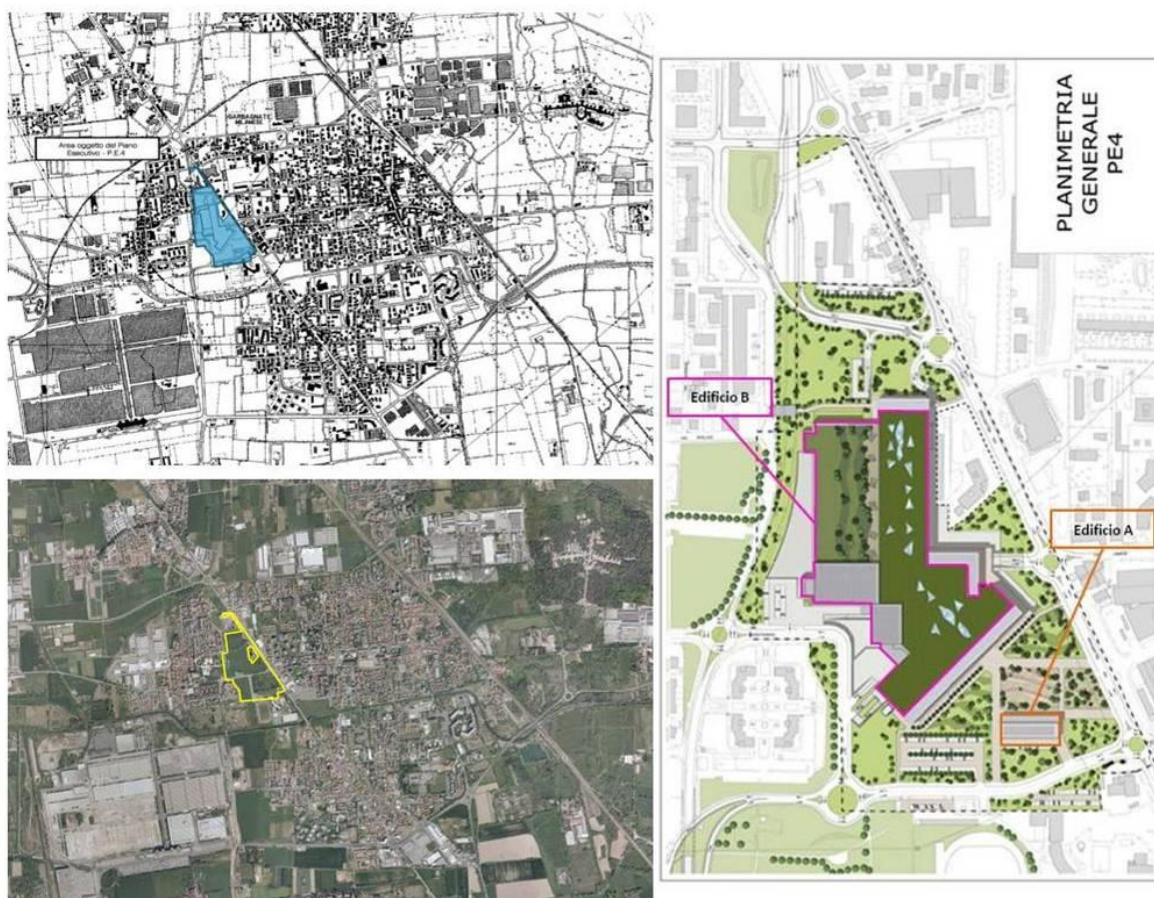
Delimitazione dell'area interessata dal PE4 e planimetria del progetto
